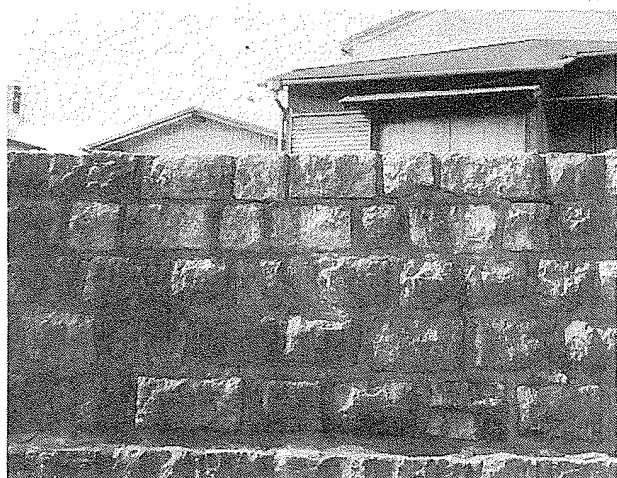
本町の石積護岸 - 間知石整層積 (撮影：昌子住江)
